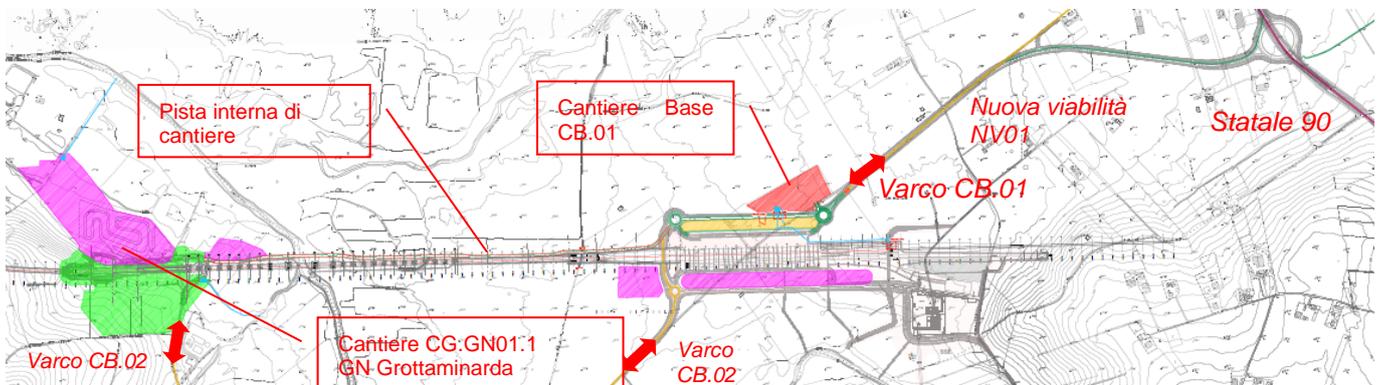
Area Grottaminarda: inquadramento generale sistema di cantierizzazione
